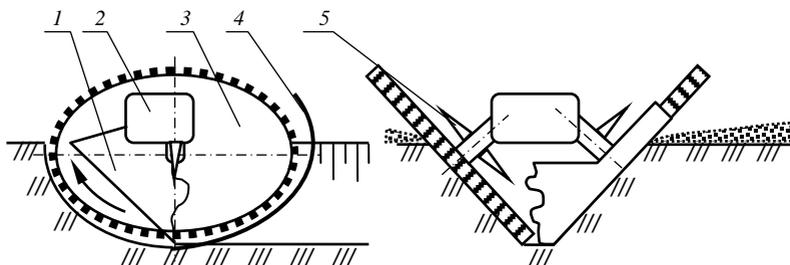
Схема рабочего органа двухфрезерного экскаватора-каналокопателя:
